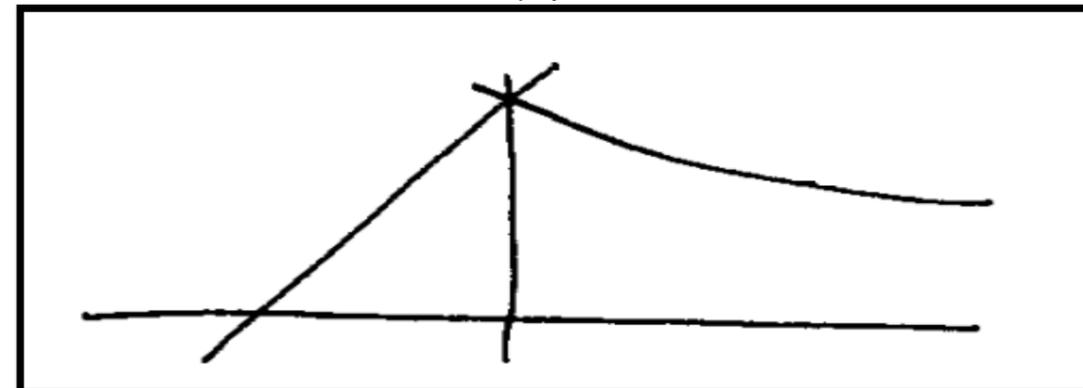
estructura colgante, Coliseo, Fuente: e-Lexia.com
